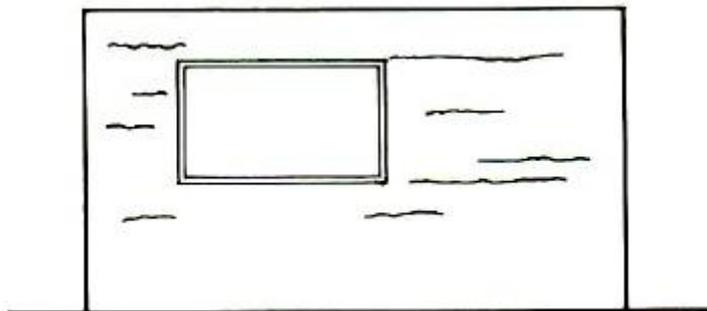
Fissuras horizontais no revestimento provocadas pela expansão da argamassa de assentamento
